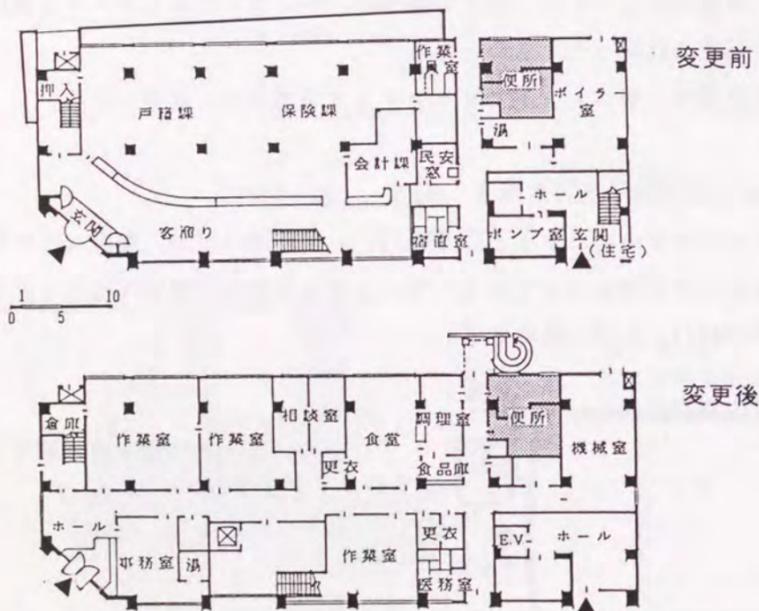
<23>京都市みぶ学園(旧朱雀支所)1階平面図
